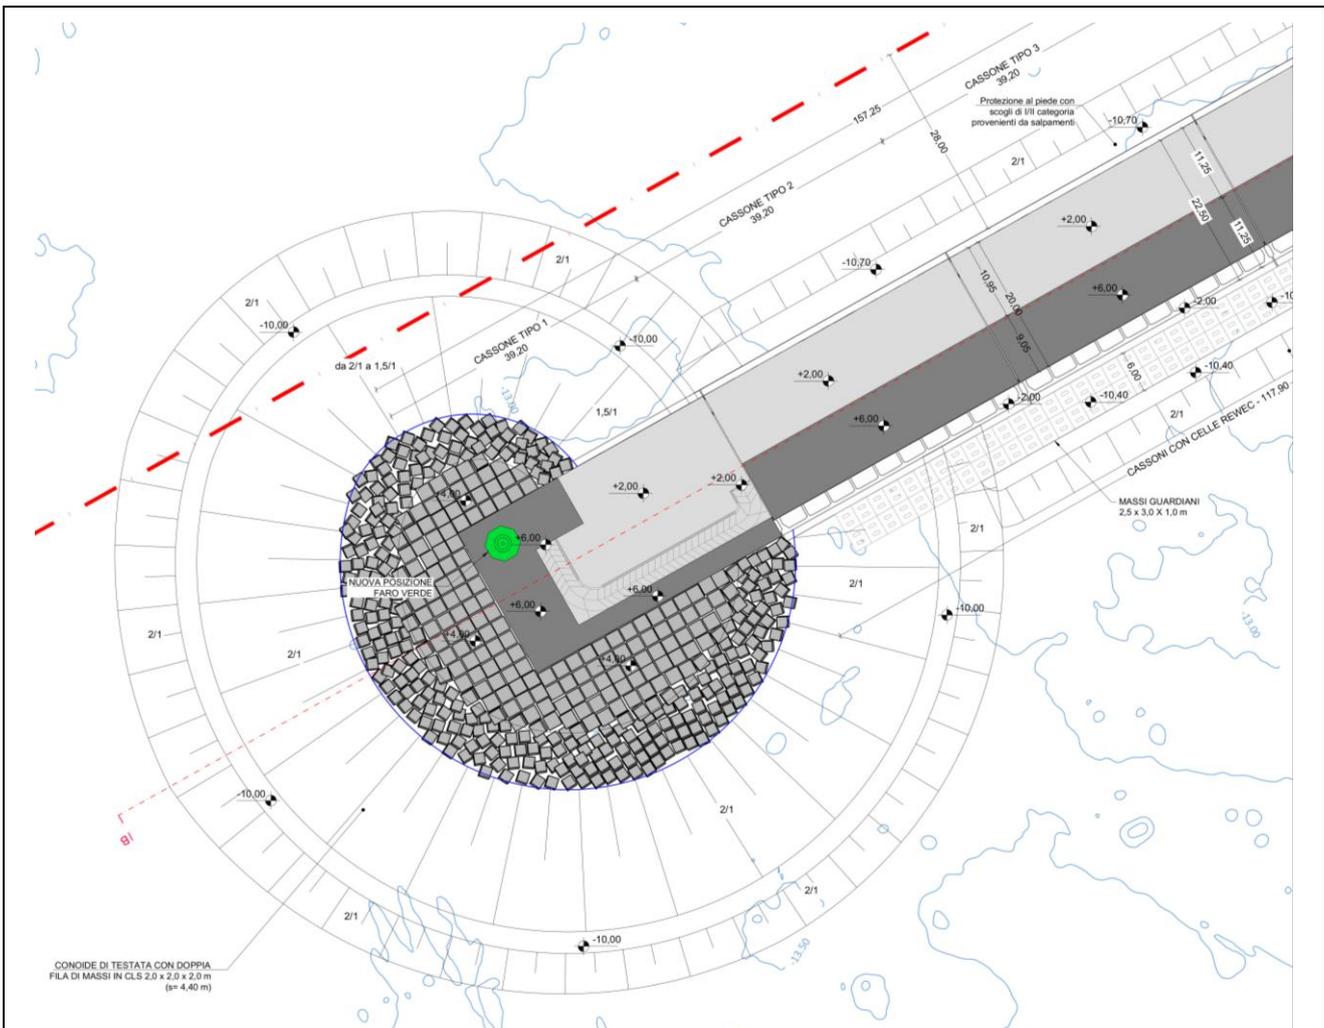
Soluzione di Variante: Prolungamento Molo Sopraflutto – stralcio planimetrico conoide di testata
